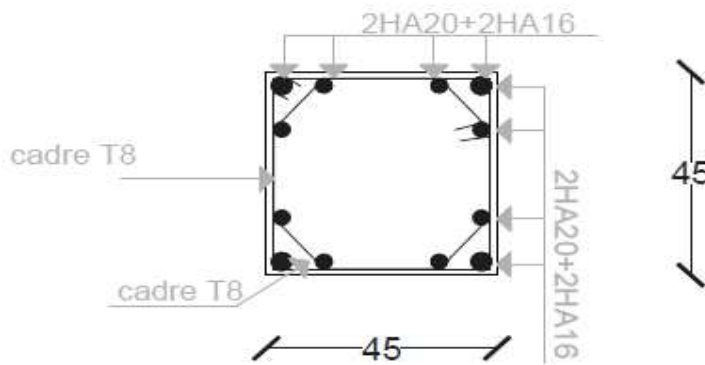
Schéma de ferrailage de poteaux carré 45x45
